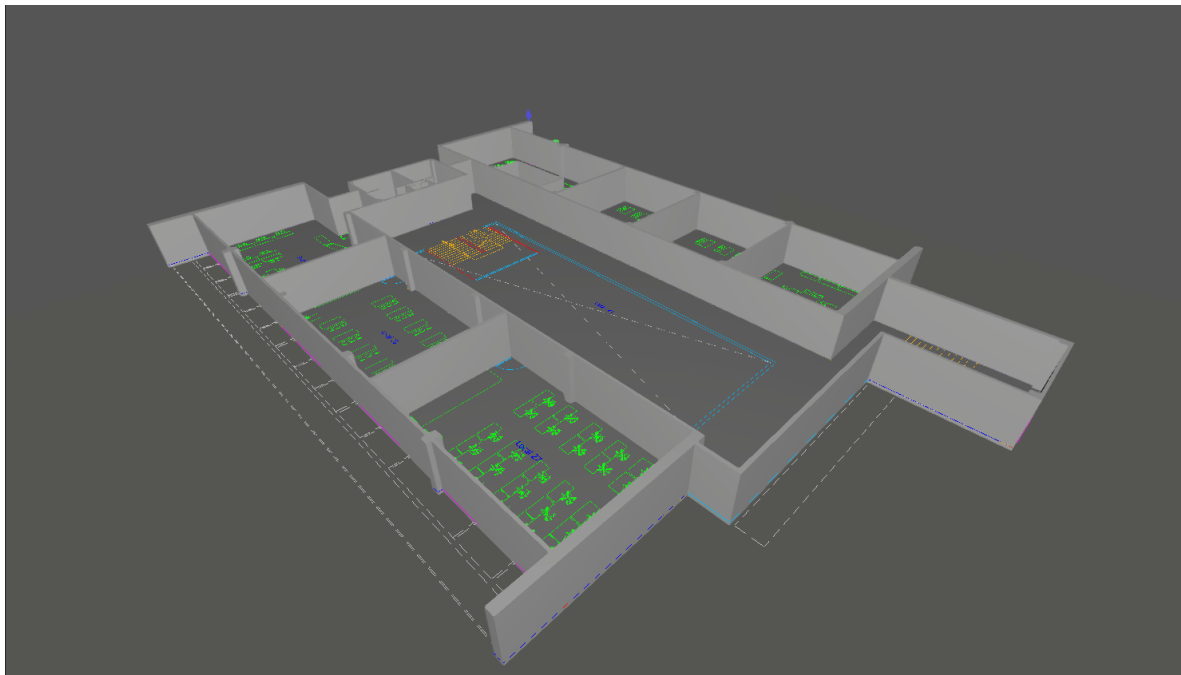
Contorno interior delimitado de la planta 3 de la edificación.
